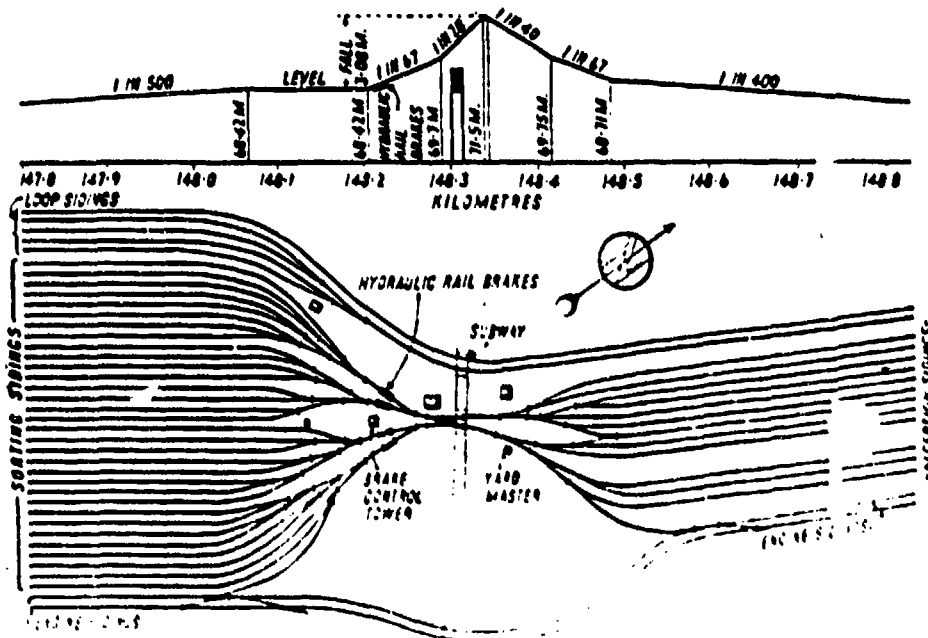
Lageplan des Bahnhofes Hamm i. Westf.
